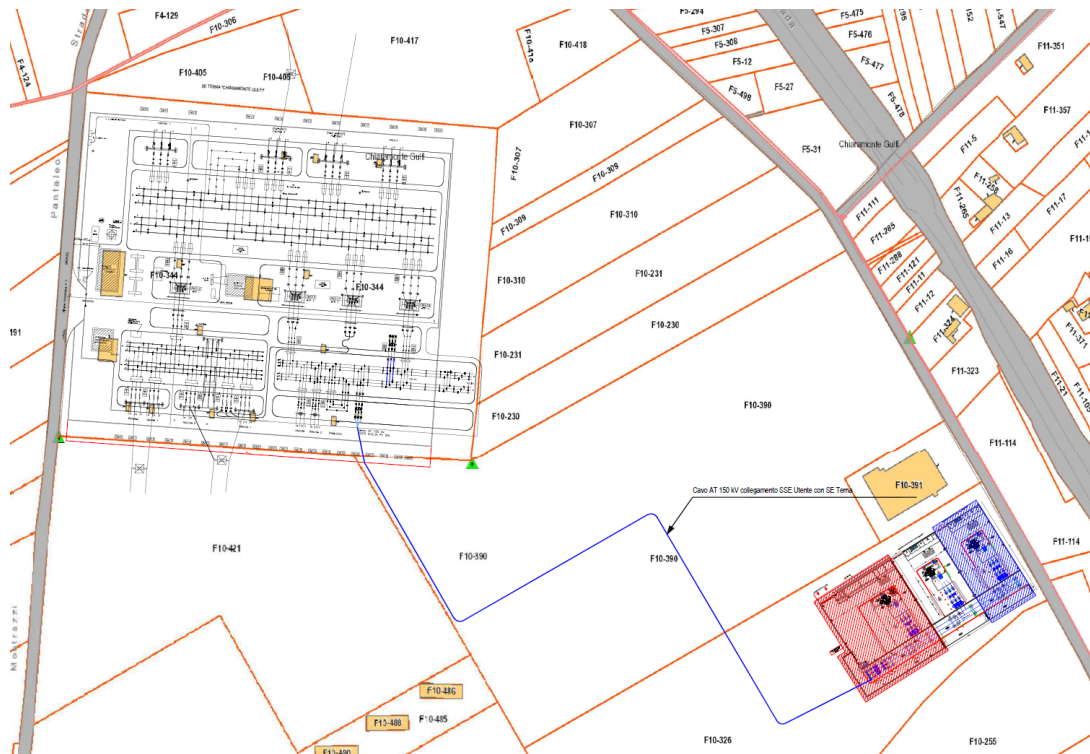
Planimetria generale SSE Chiamonte Gulfi (RG) e Stallo condiviso
